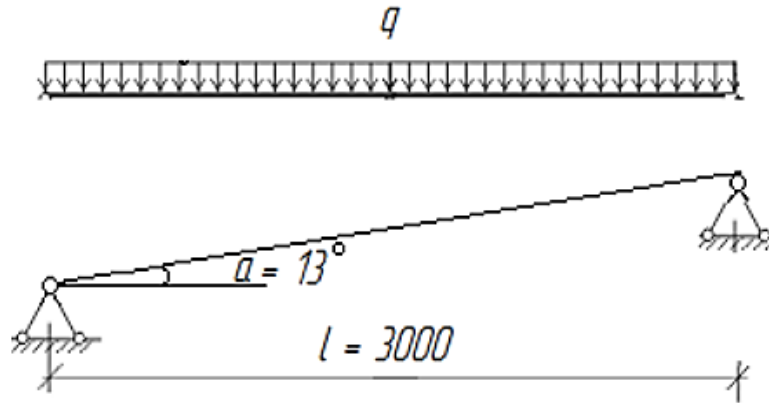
Расчетная схема однопролётной стропильной ноги
